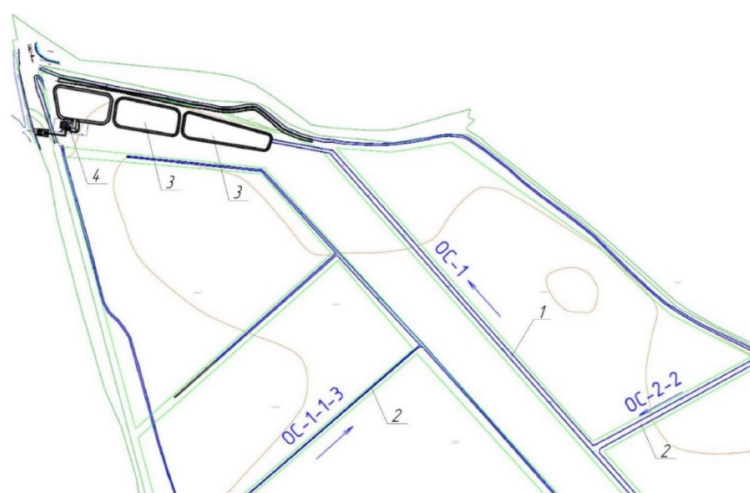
Фрагмент осушительной системы на подтопляемых и переувлажняемых сельскохозяйственных землях Темрюкского района Краснодарского края:
